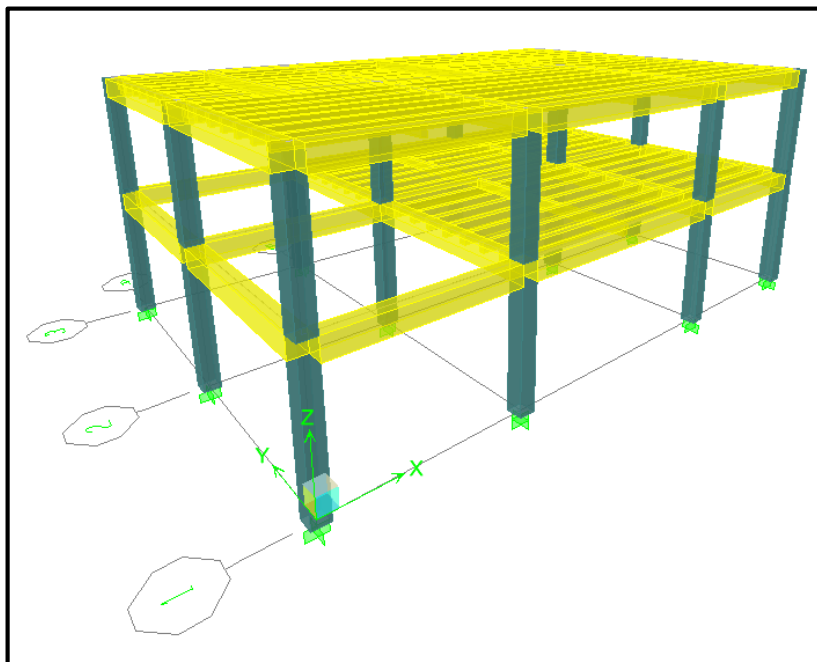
Vista 3D Edificio Pasarela (Fachada Norte y lateral Oeste)
